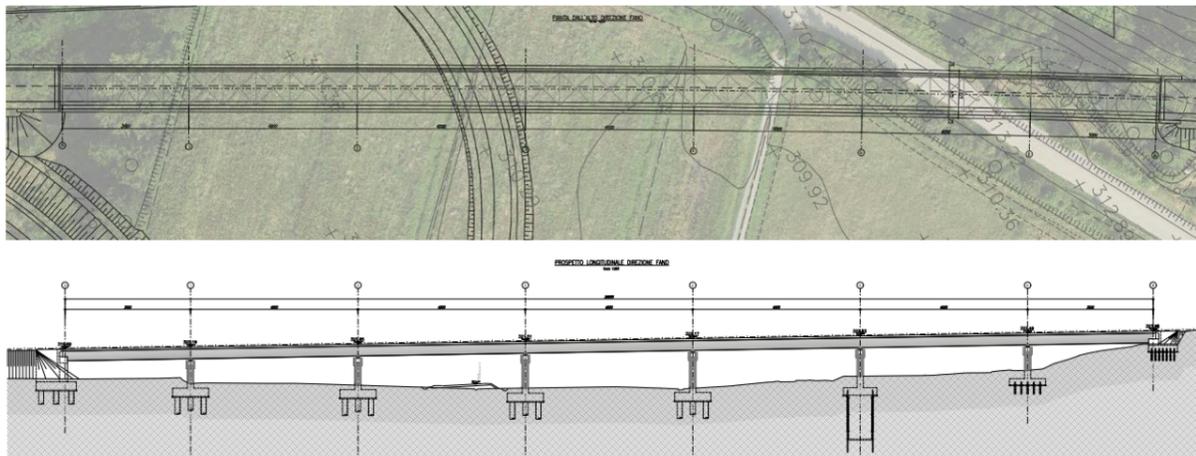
Pianta e profilo longitudinale carreggiata direzione Fano
